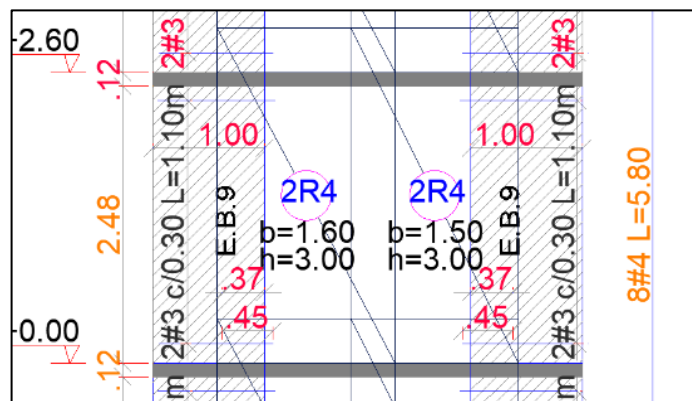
Perfil de muro con elemento de borde 9 (E.B.9)
